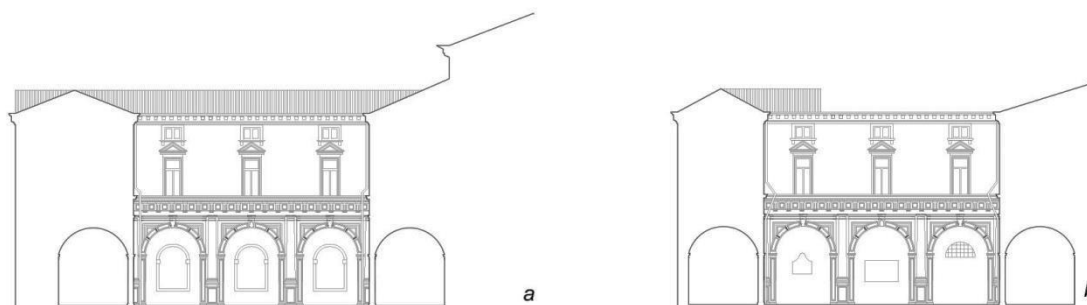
prospetti del chiostro dorico interno: a) prospetto orientale; b) prospetto meridionale.
